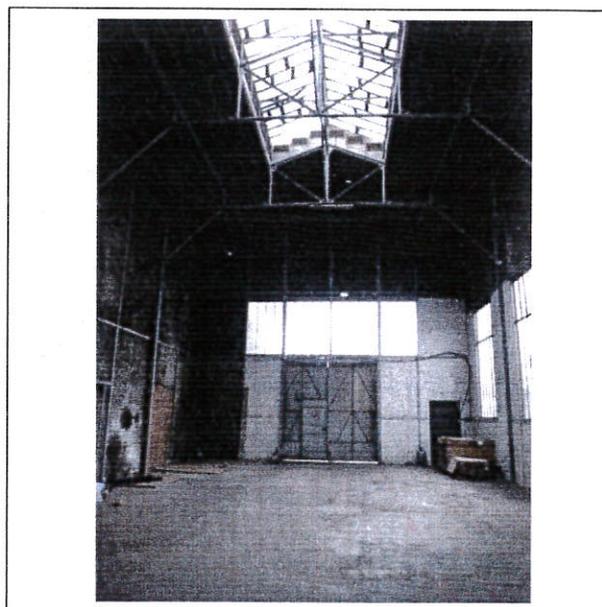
vue d'un autre bâtiment de stockage au centre du site.
